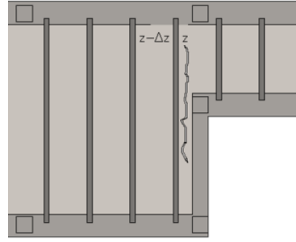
Fisuración en cara inferior de forjado por cambio de rigidez de viguetas
